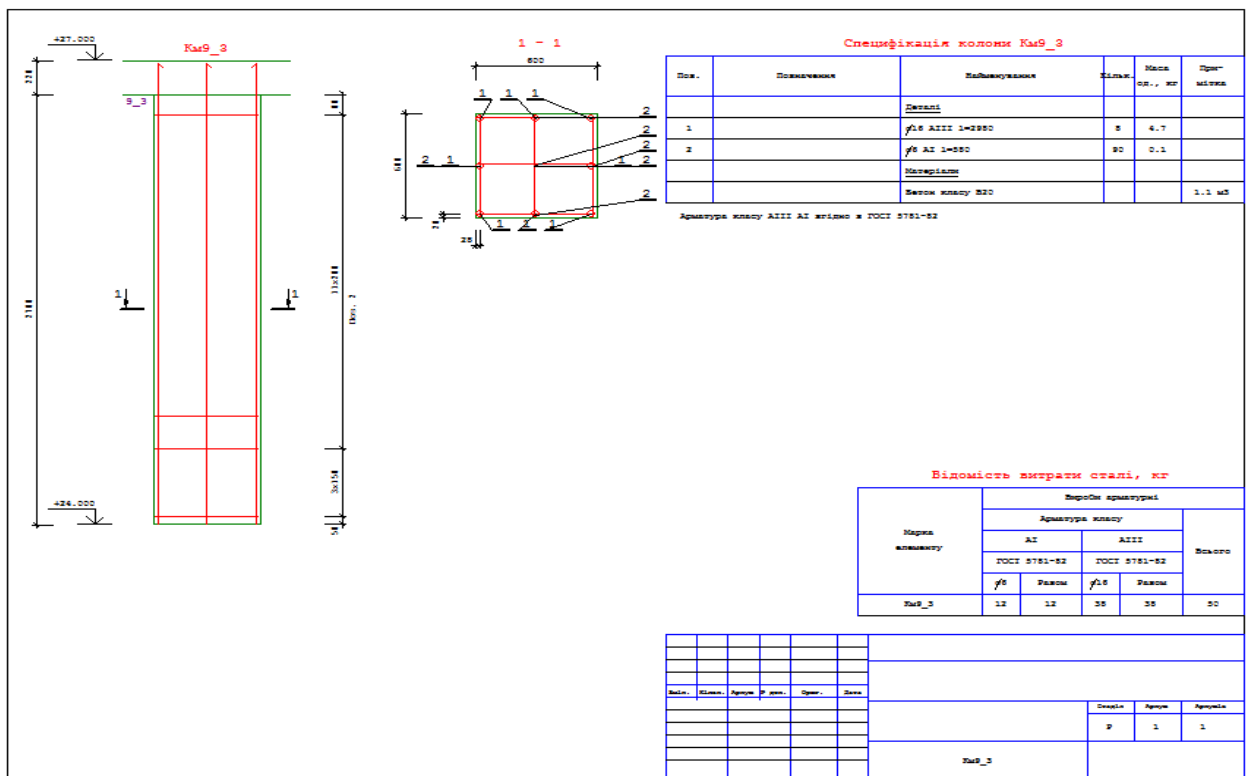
Варіант будинку з плитними перекриттями. Колона К9-3. Креслення робочого проекту
